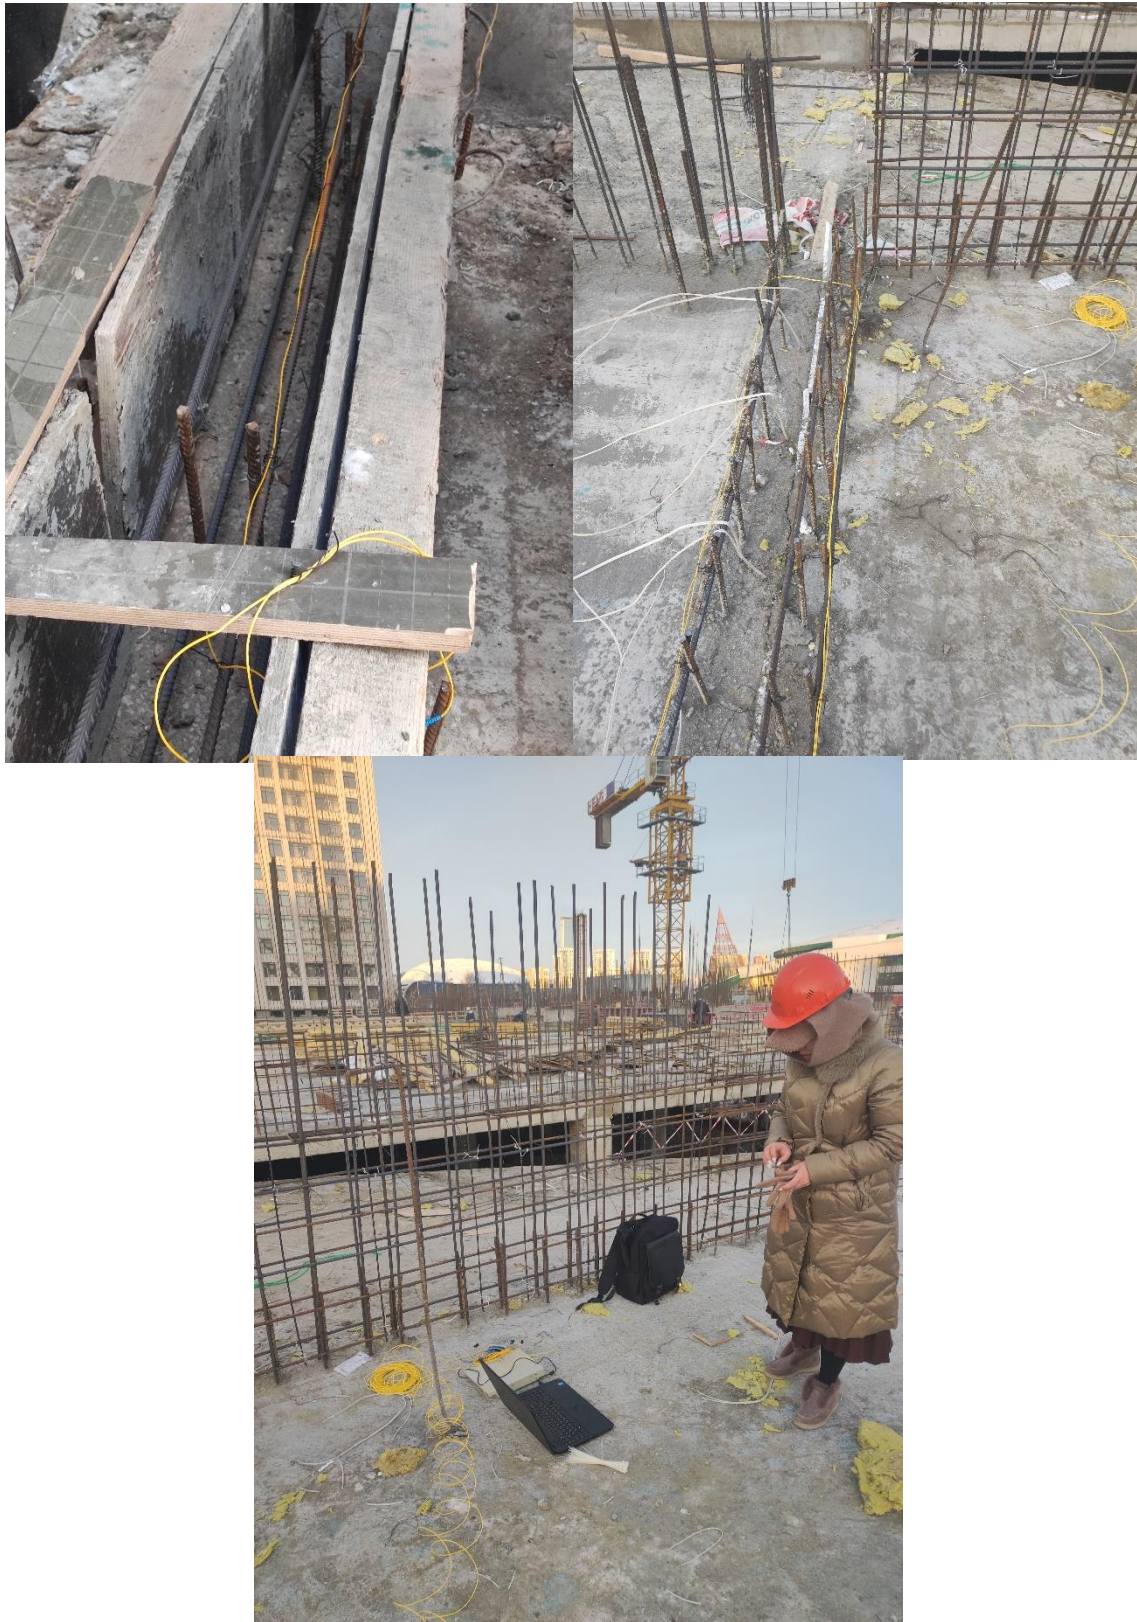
Г – Подготовительные мероприятия по закреплению ОВ на арматурных стержнях плит перекрытия, колон и фундамента
